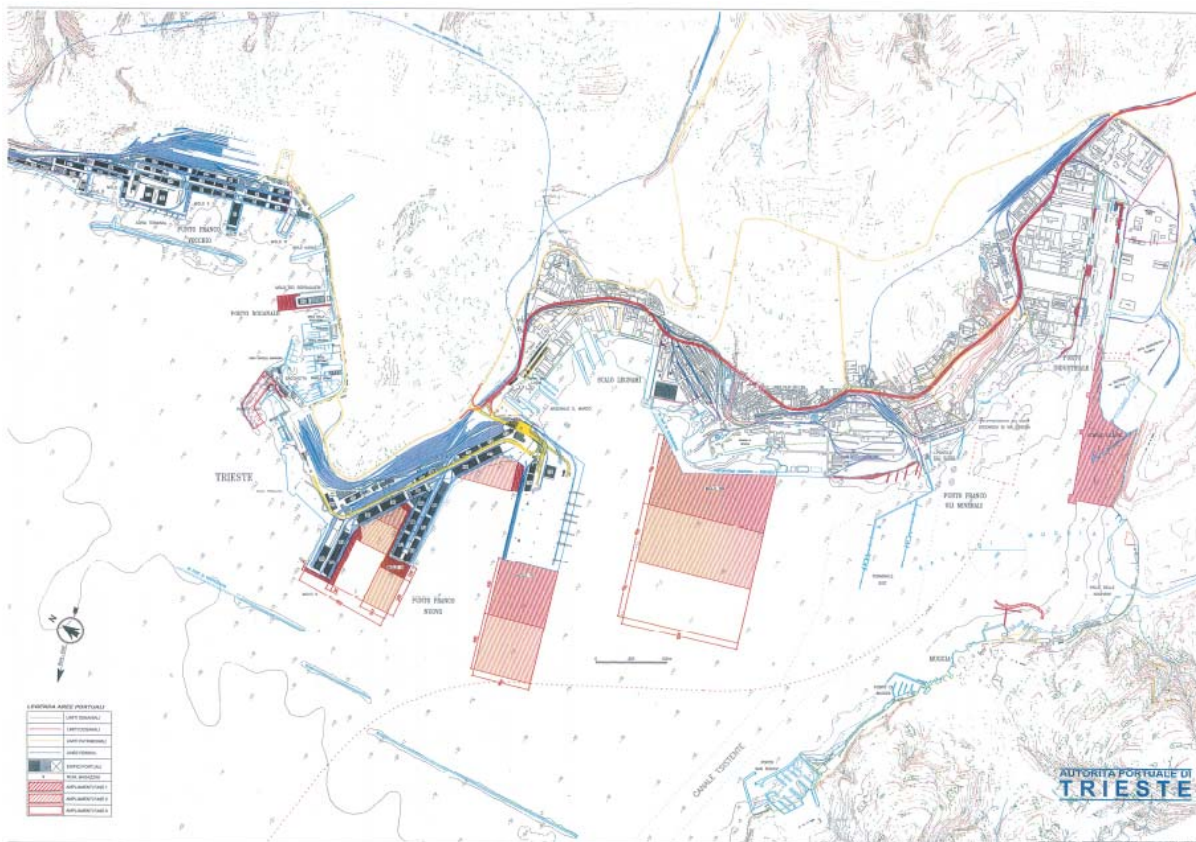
Bozza di planimetria del PRP in fase di definizione.
